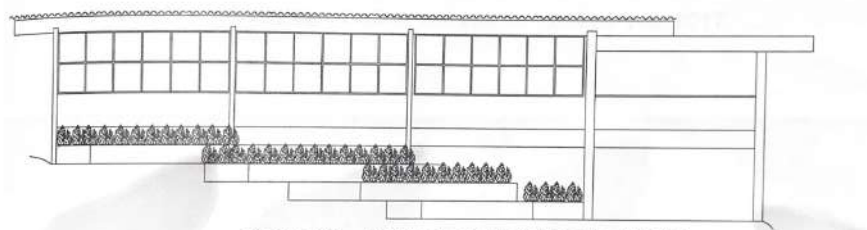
Fachada do Hotel, Fonte: BRITTO,2018
